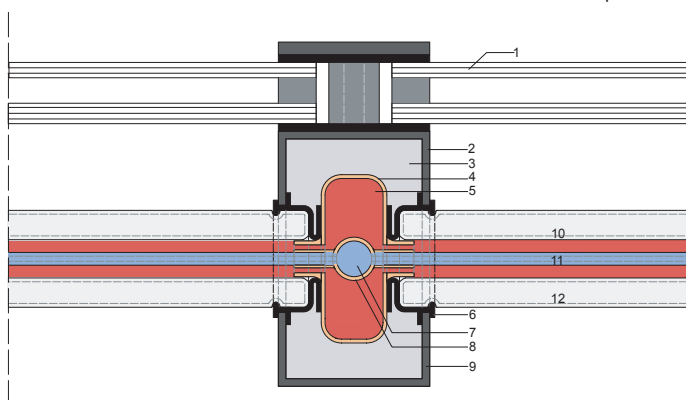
Fassadenpfosten mit integrierter Medienführung
